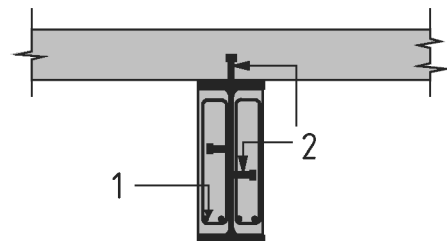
Viga de acero con parcialmente embebida en hormigón
